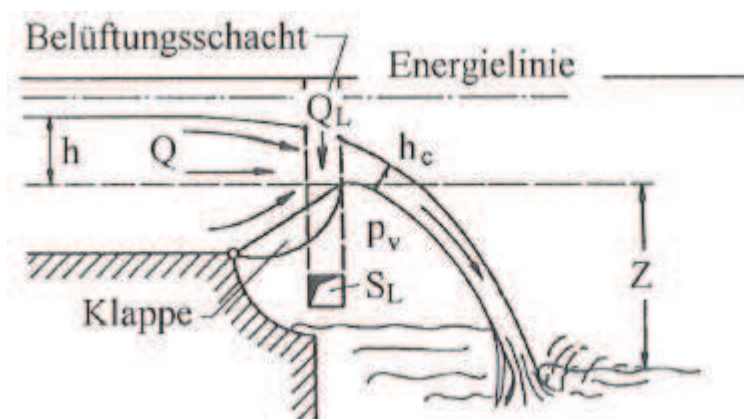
Belüftung einer Fischbauchklappe [1]
